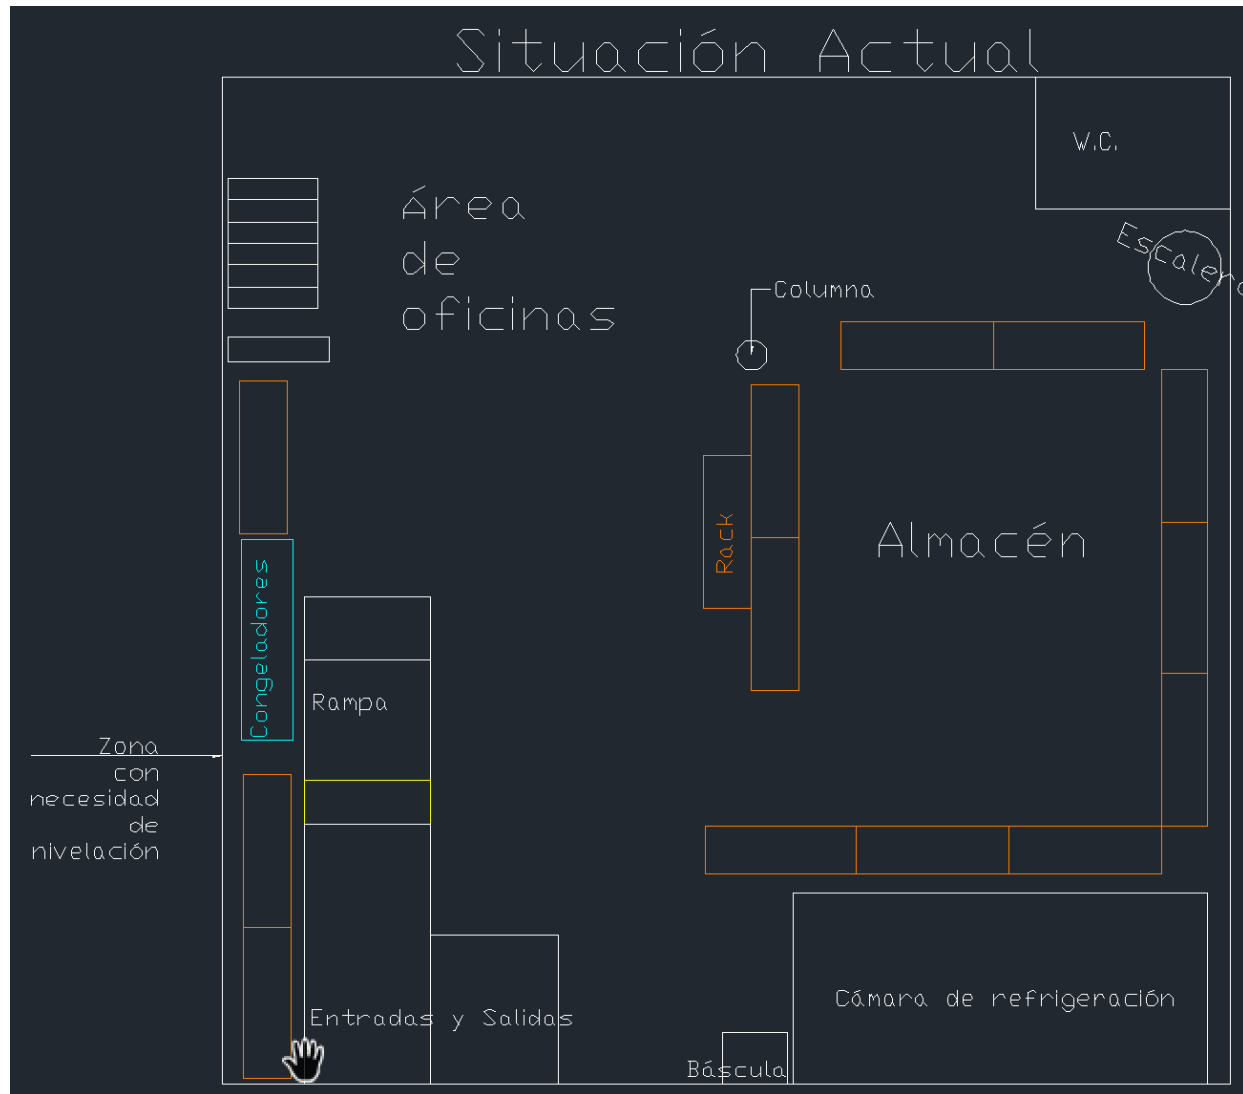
Layout de la situación actual del almacén. Fuente: AutoCAD.
